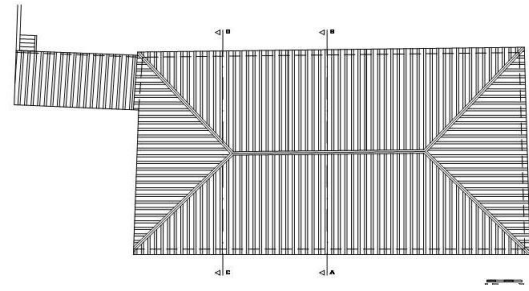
Planta do Cobertura, Estratégia, Autor, 2017
